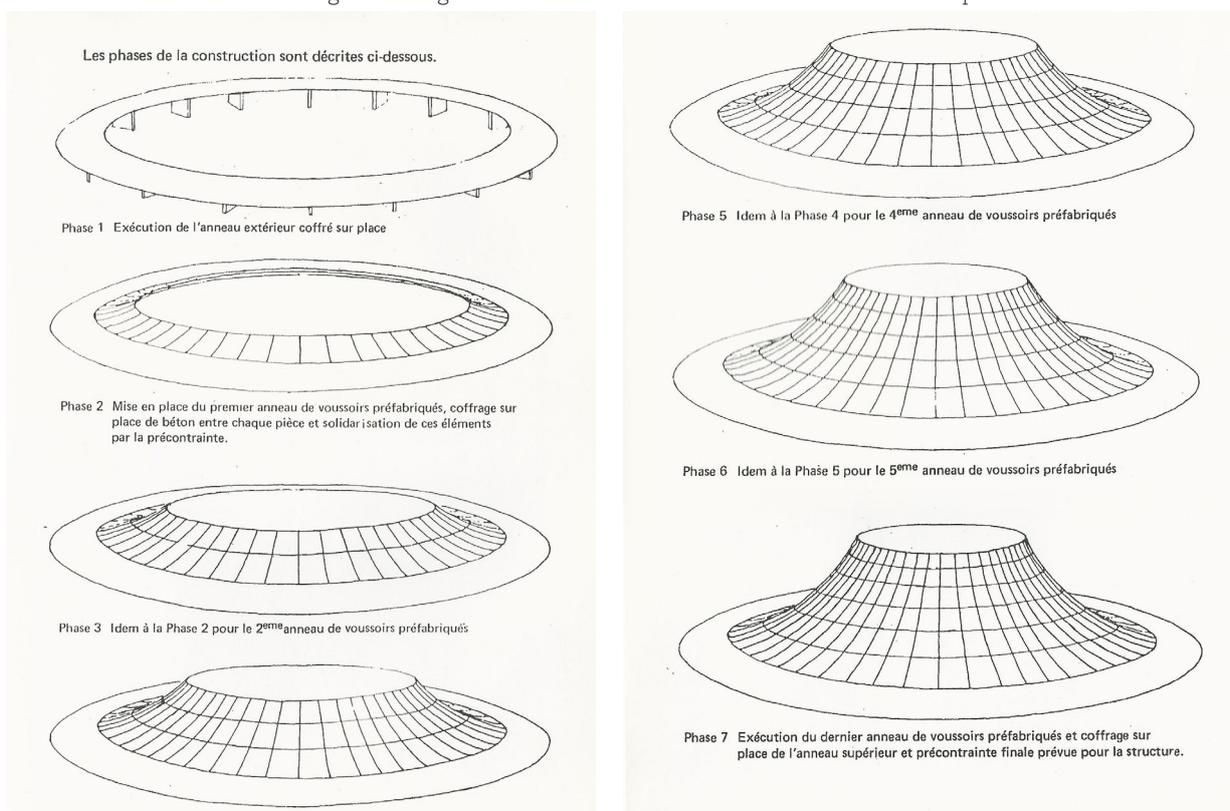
Esquema de montagem da estrutura de concreto armado da cobertura dos vulcões.
